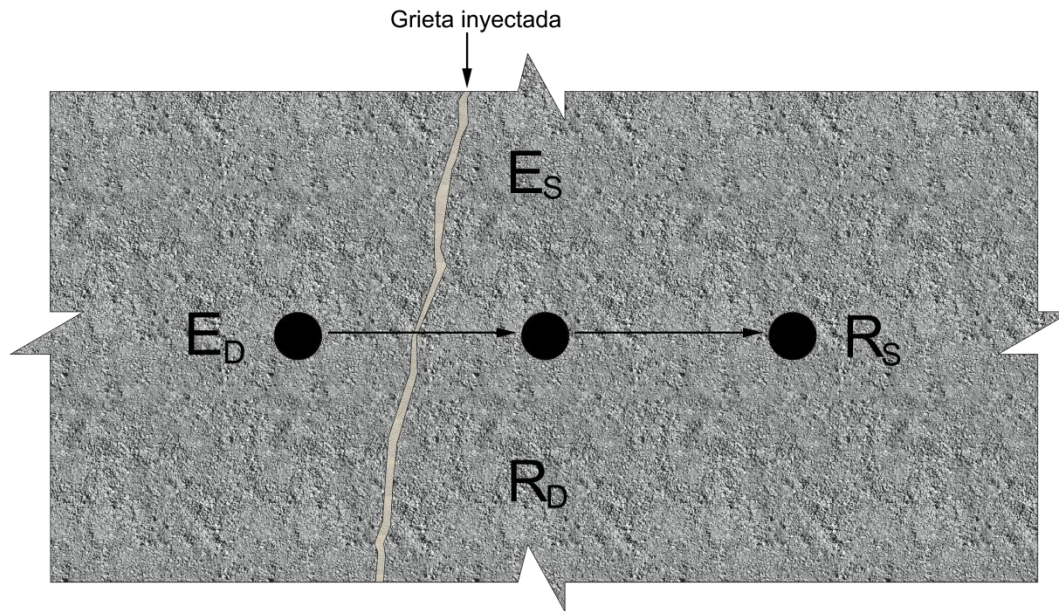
Columna de concreto después de la inyección. Fuente: Jorge Abarca, 2019.
